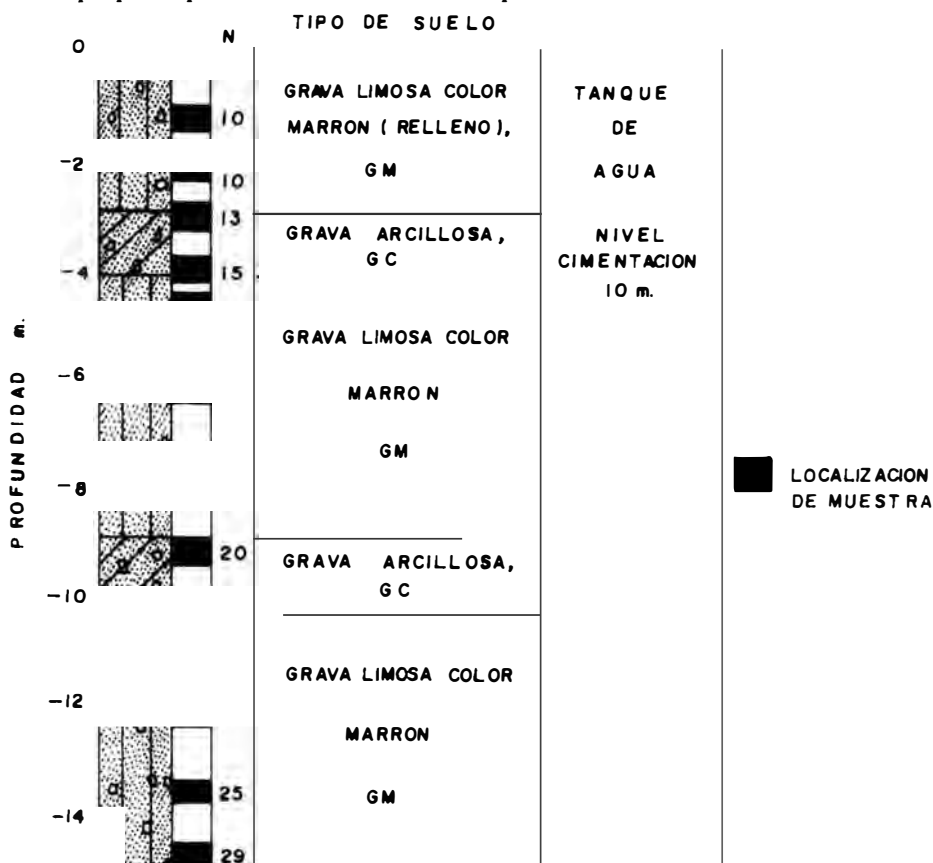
Sondaje para planta de tratamiento de agua en Stockton, Utah
